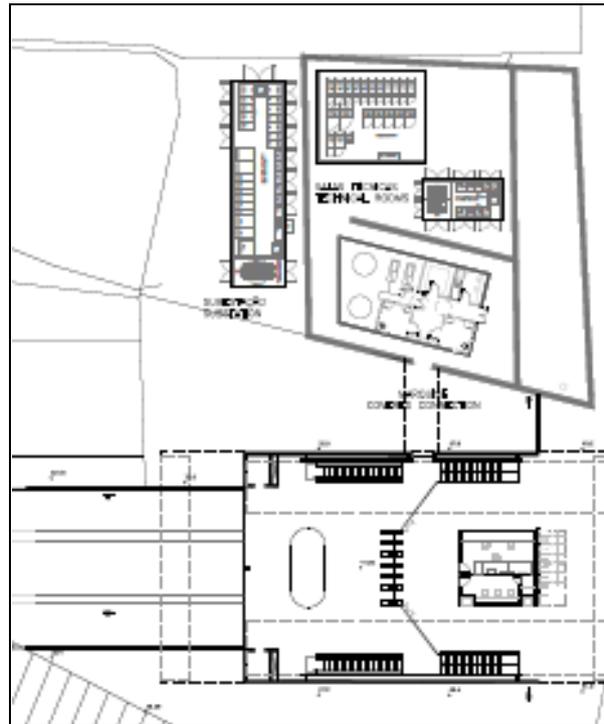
Planta Baixa da Parada Soledade e do Edifício Solar Bandeira.
